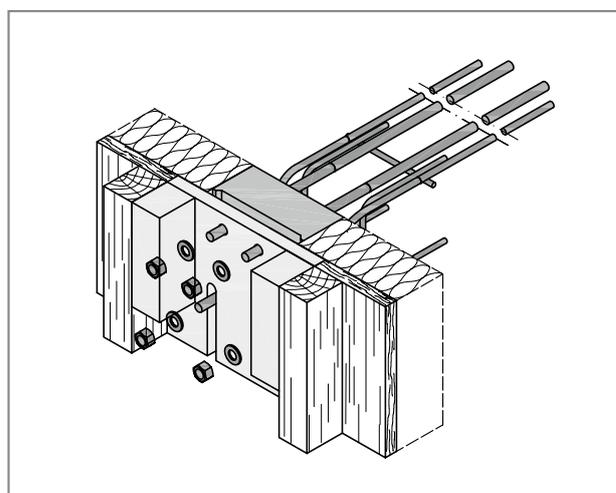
Schöck Isokorb® T type SK : aide au montage inversée pour permettre une isolation parfaite des bords de la dalle en cas de mur monolithique
